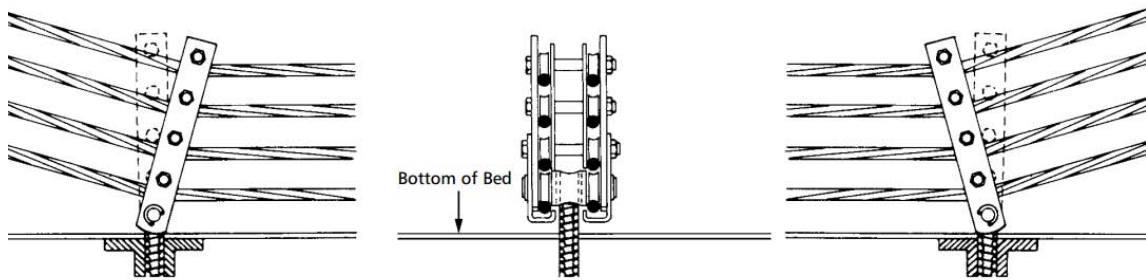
Depresores multitorón. (Dayton Superior; Concrete Prestressing Handbook)
